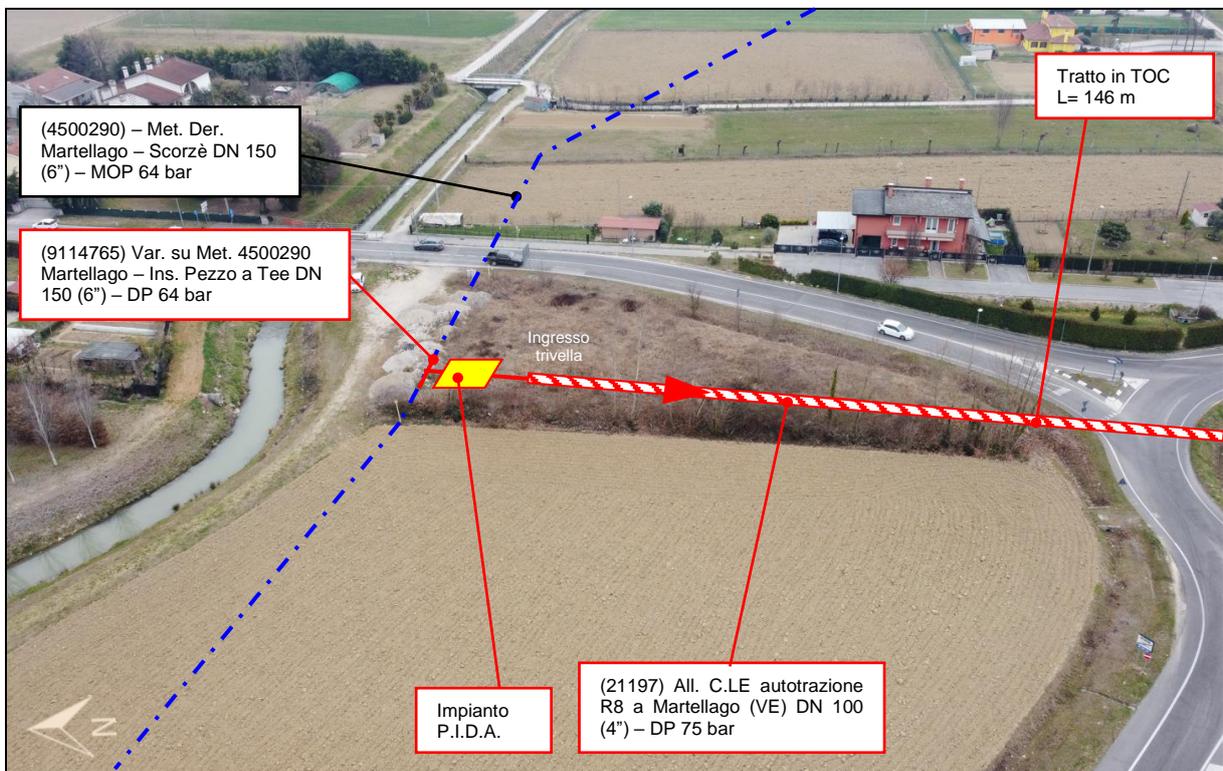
Impianto PIDA in progetto e tratto in Trivellazione Orizzontale Controllata.
